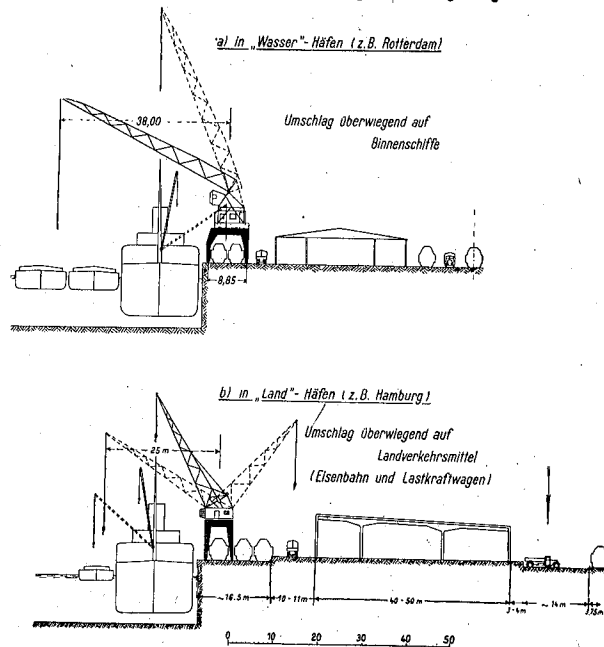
Querschnitt durch eine moderne Stückgutumschlaganlage
